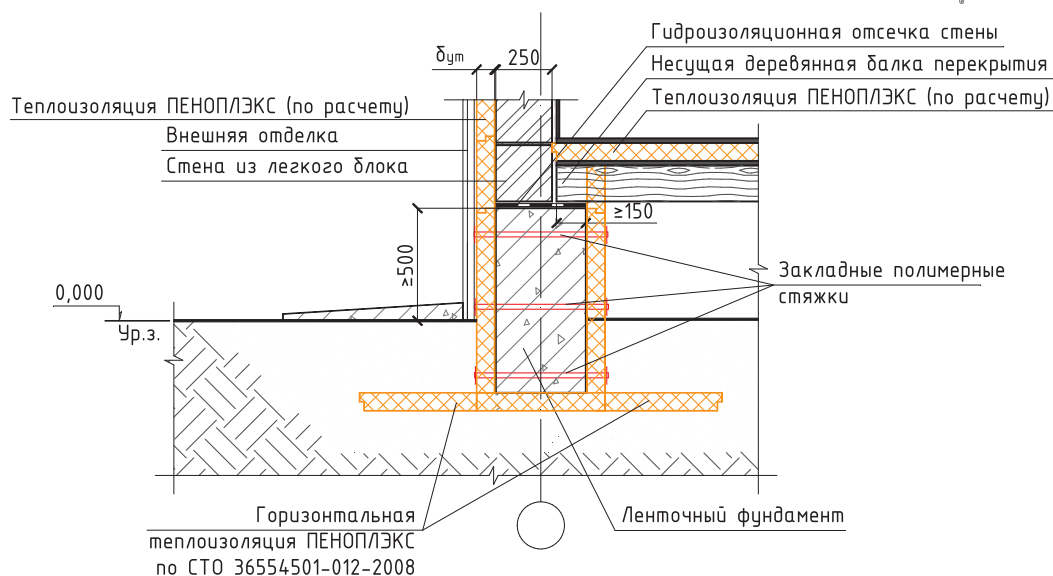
Схема устройства несъемной опалубки из плит ПЕНОПЛЭКС® с использованием закладных полимерных стяжек при возведении ленточного фундамента.
